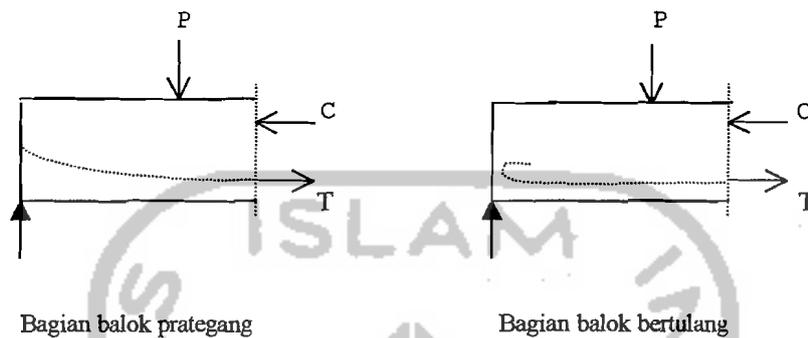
Distribusi tegangan sepanjang penampang beton tendon eksentris
